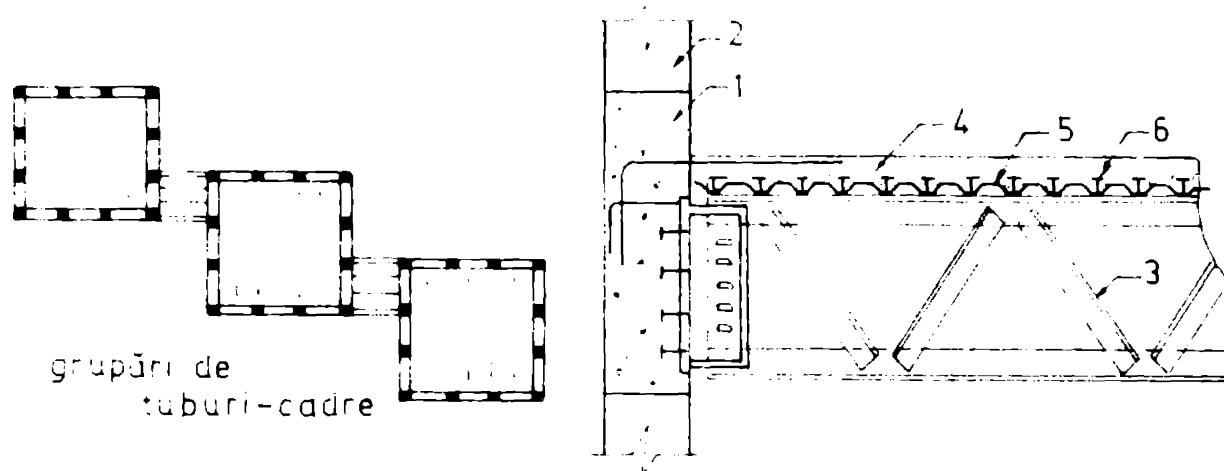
1-Grindă cadru beton armat exterior. 2-Stîlp beton armat 3-Grindă cu zăbrele planșeu compus. 4-Placă beton armat. 5-Profil tablă cutată. 6-Elemente de legatură tip dorn cu cap
